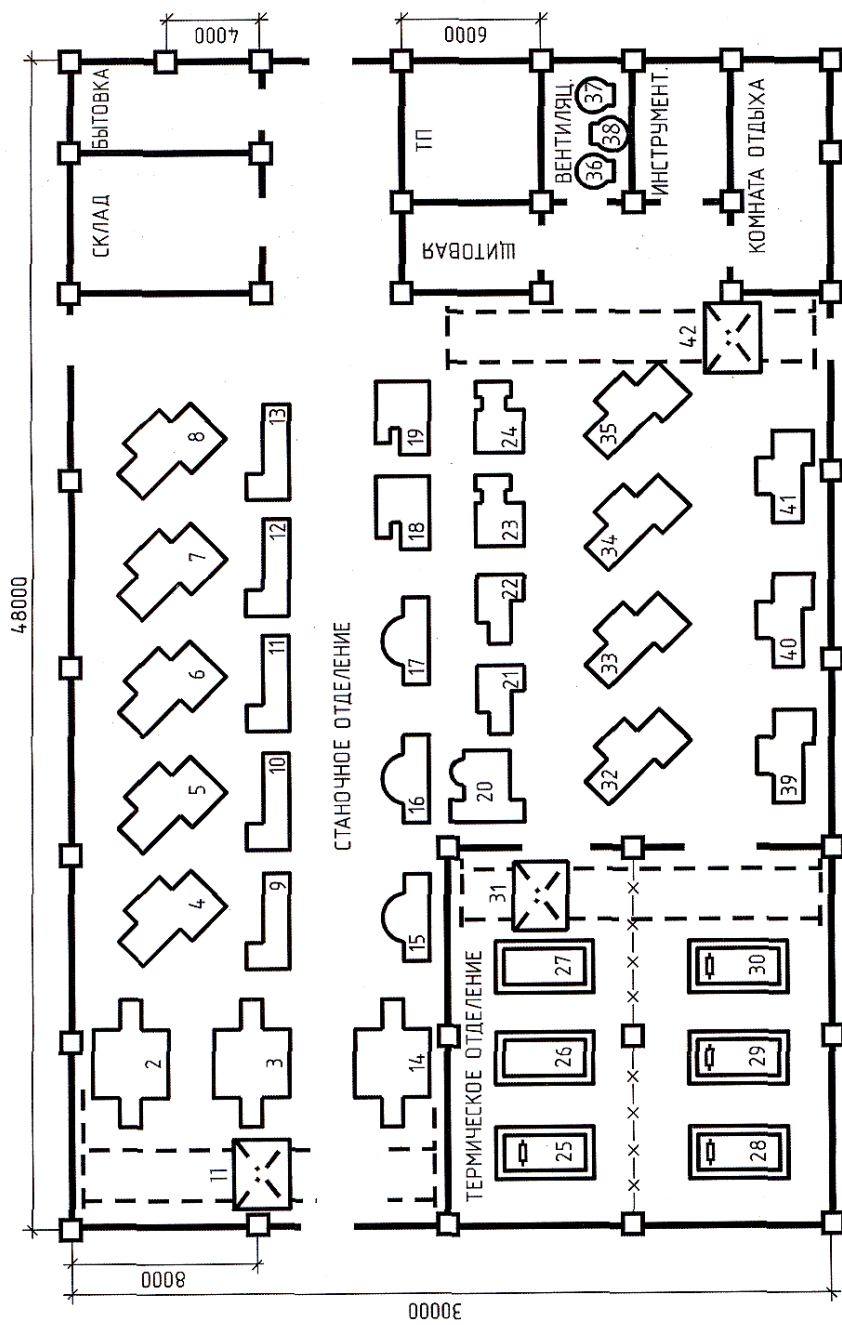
План расположения ЭО цеха металлоизделий
